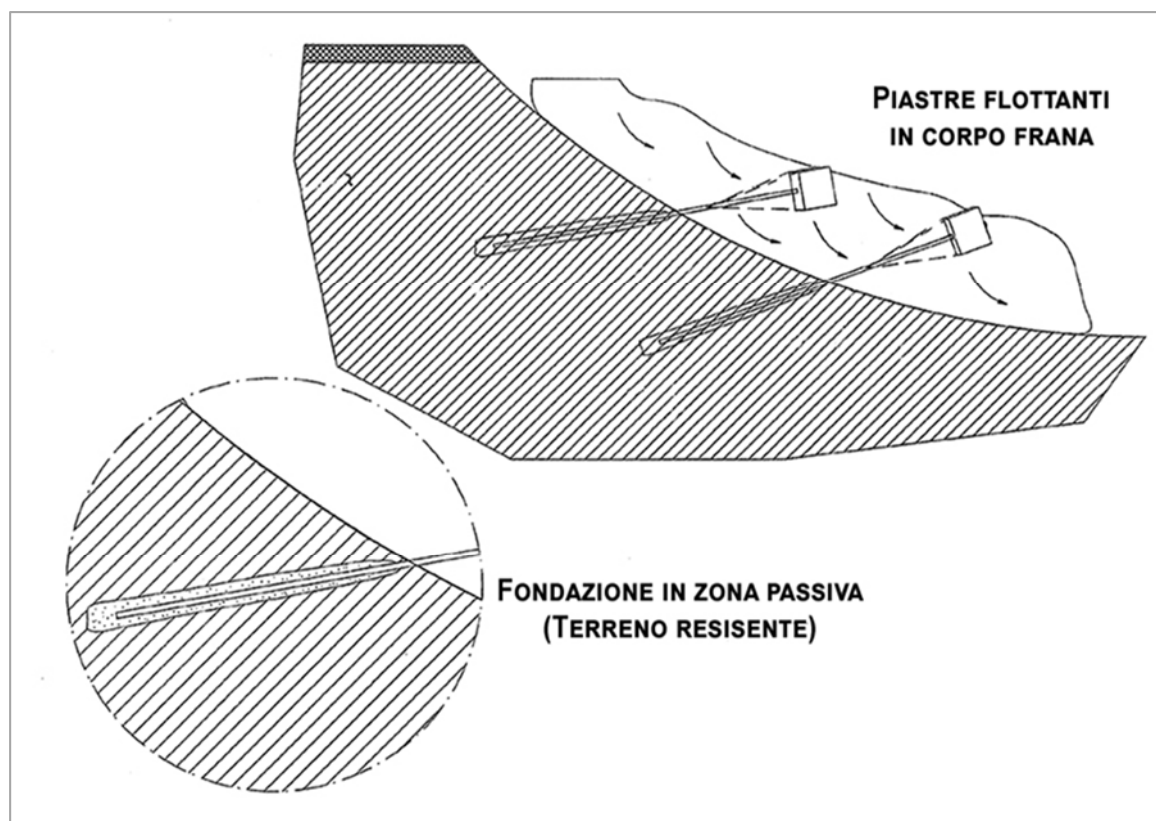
Schema di una disposizione tipo delle piastre flottanti in corpo frana, con particolare della fondazione dei rinforzi nel terreno resistente.
